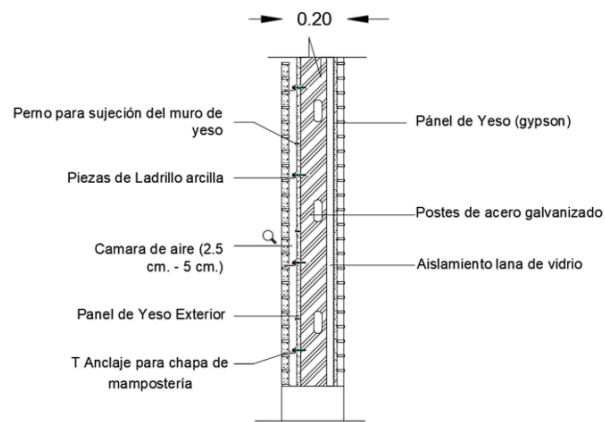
Detalle constructivo de mampostería exterior con revestimiento de ladrillo
